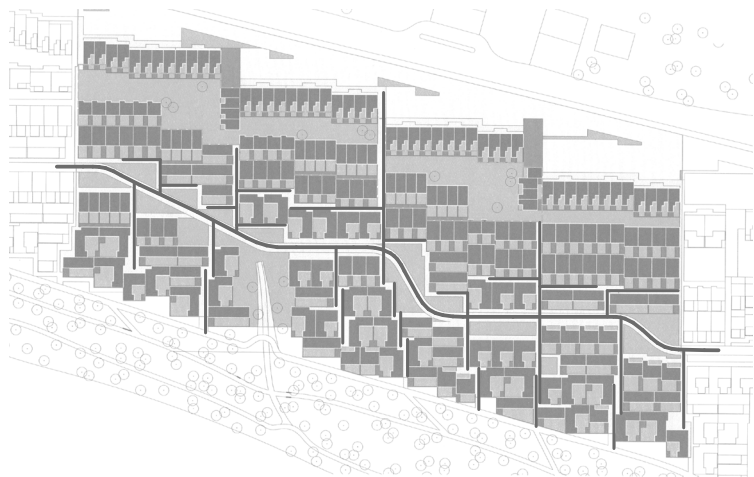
Lageplan, Maßstab: 1 : 5.000
